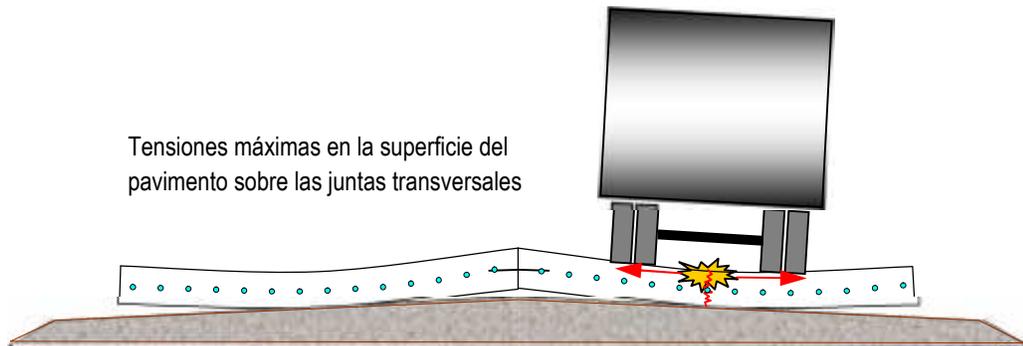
Esquema de la generación de fisuras longitudinales.
